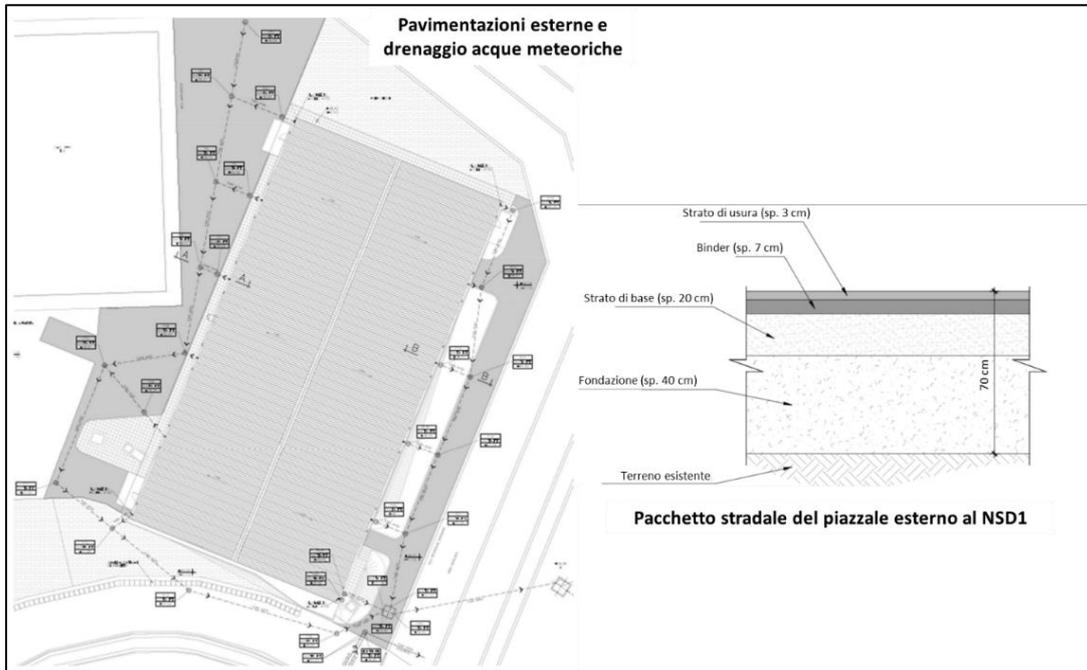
Pavimentazione aree esterne (IT ND 00130)
